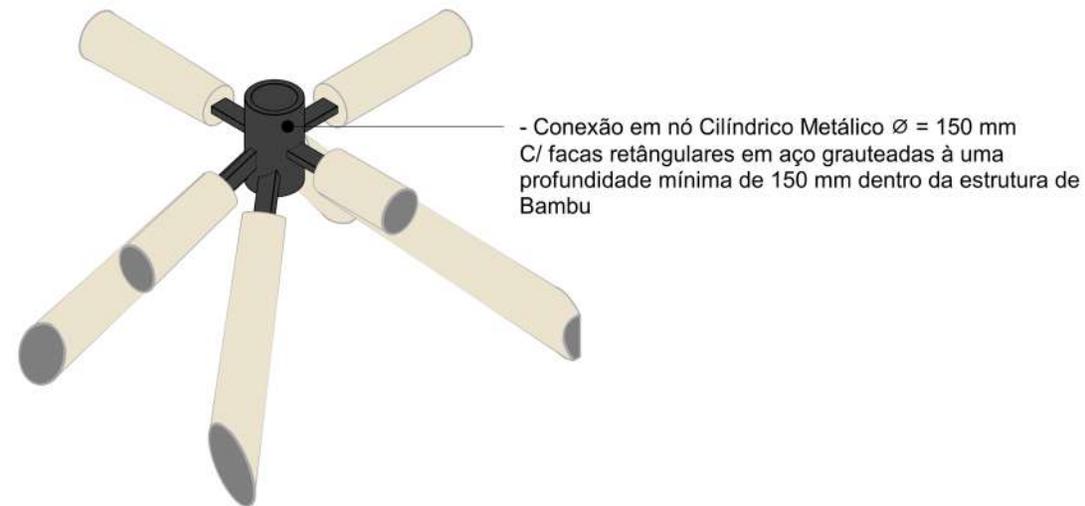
Detalhamento Conexão Metálica Treliça Espacial
